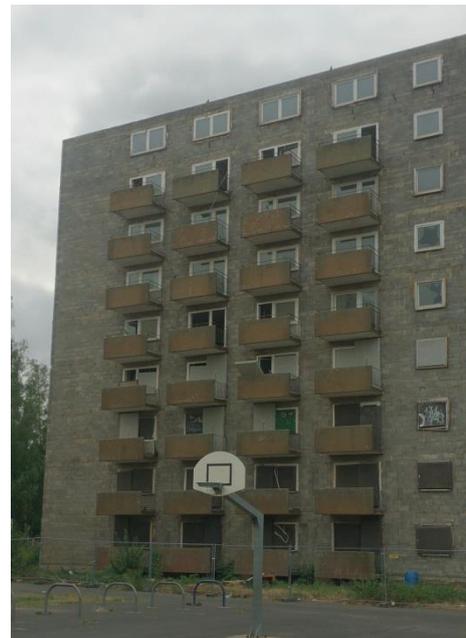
Abrisshochhaus Maastrichter Straße 5-7 mit demontierter Fassadenverkleidung
